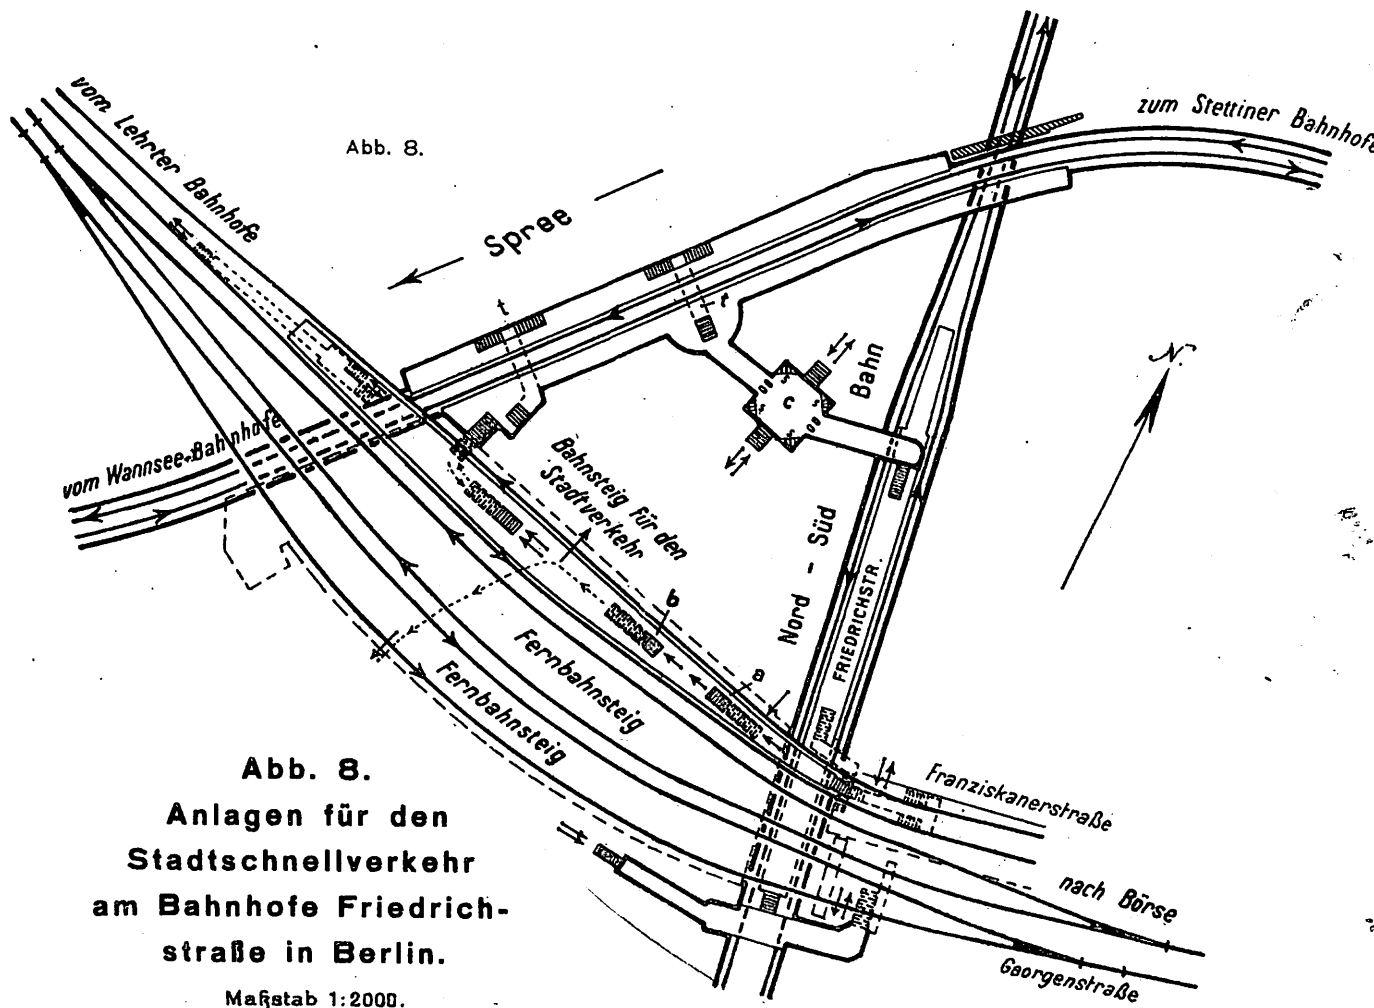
Anlagen für den Stadtschnellverkehr am Bahnhofe Friedrichstraße in Berlin.
